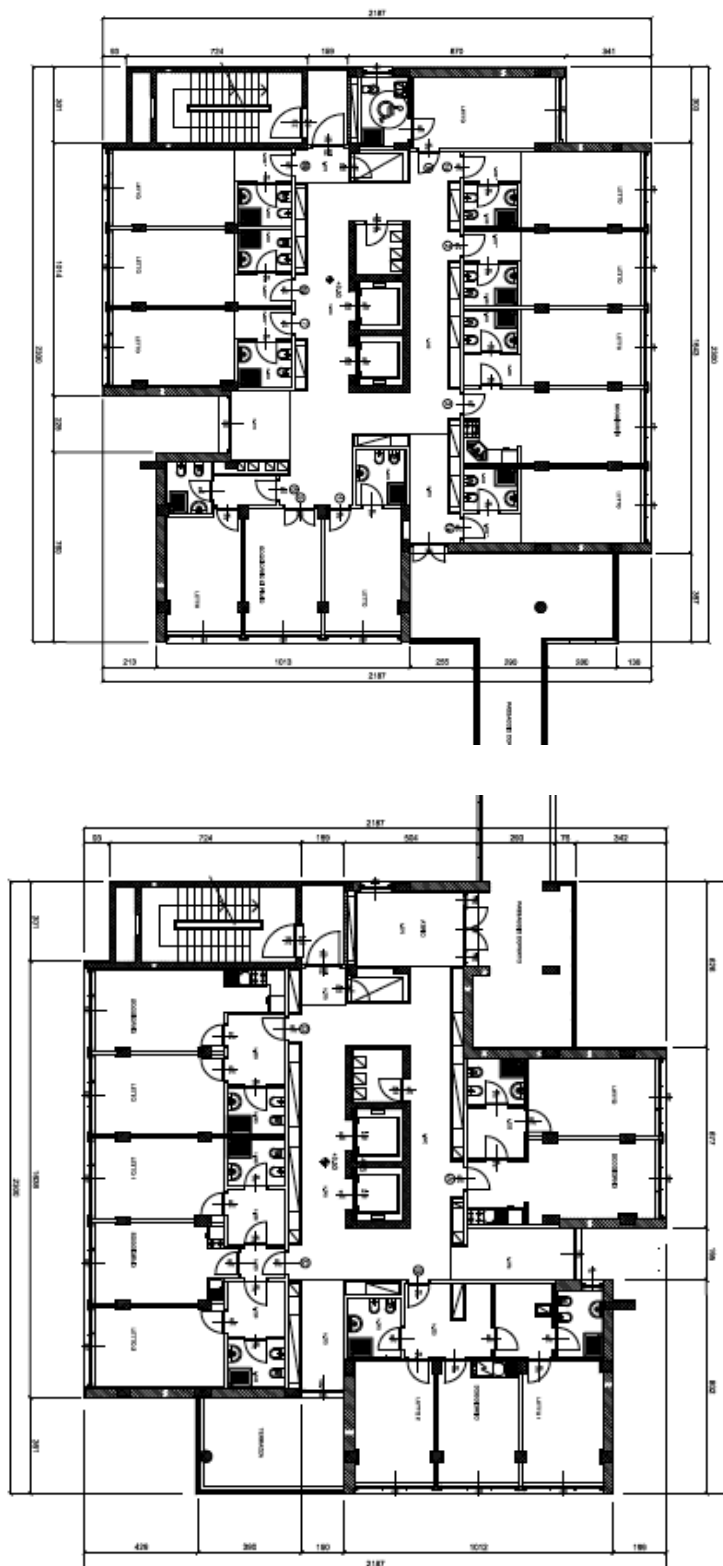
Pianta piano tipo corpi A e B – Fonte: archivio In-Domus
